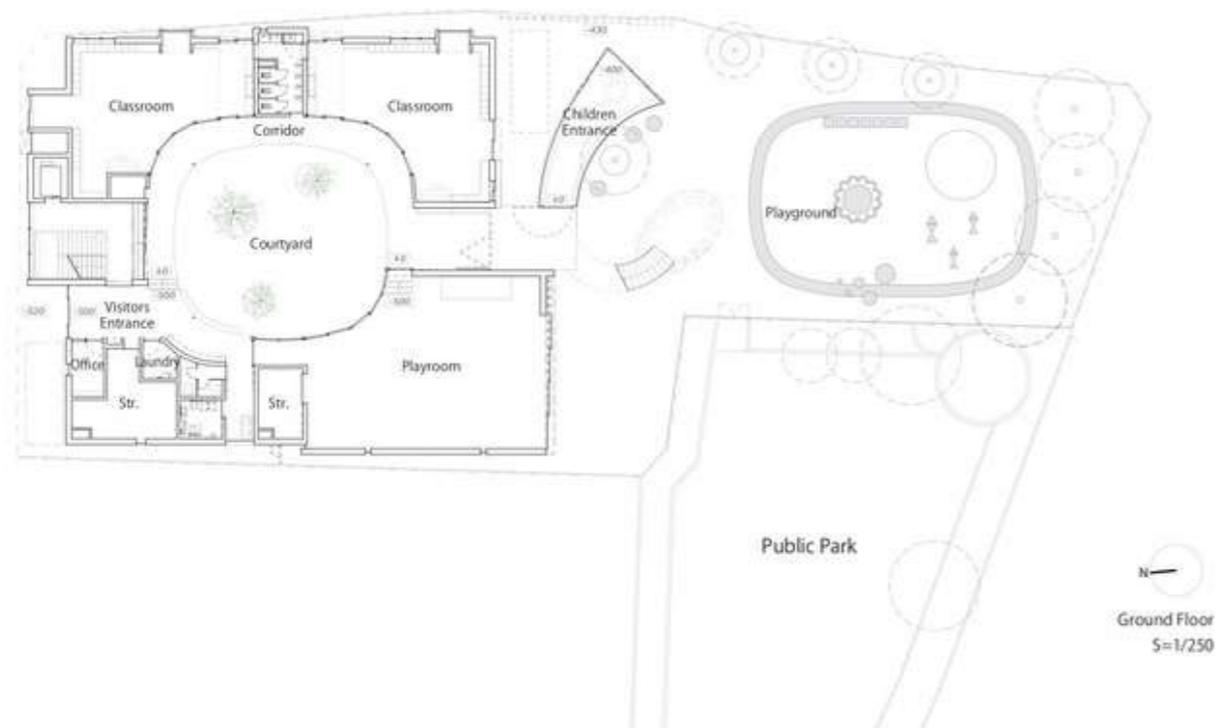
Plano planta baja. Fuente: <https://afasiaarchzine.com/2018/09/mamm-design-3/mamm-design-tomonoki-himawari-kindergarten-tokyo/>
